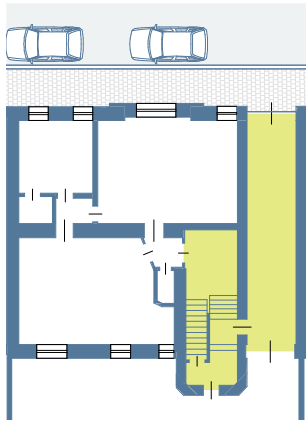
Grundriss eines Gründerzeithauses mit einer Erschließung über eine Hofdurchfahrt
